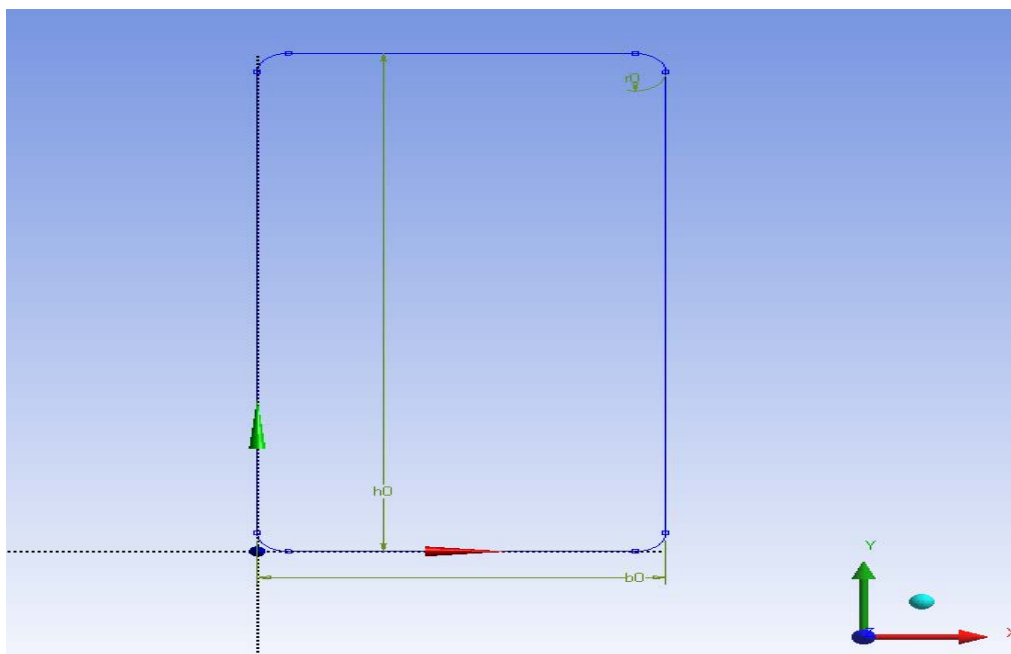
Modelo 1. Sketch de la sección transversal del cordón
